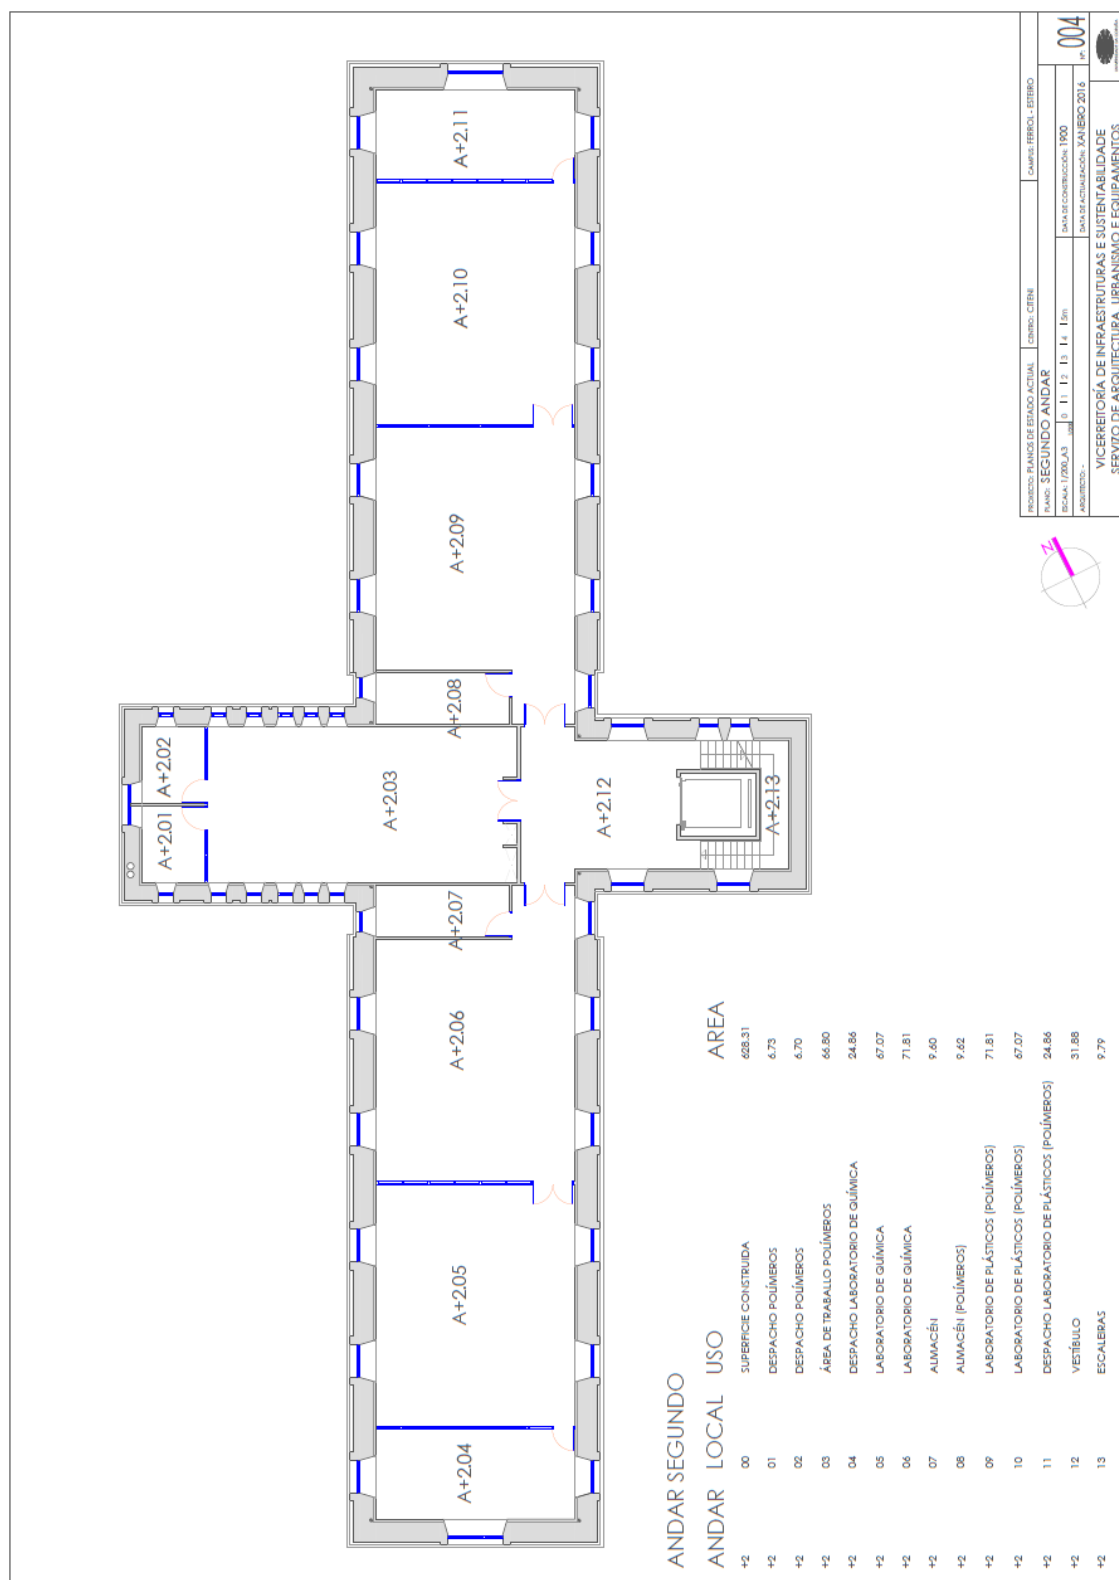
Plano de planta segunda. Fuente: Vicerrectorado de infraestructuras y sostenibilidad.
